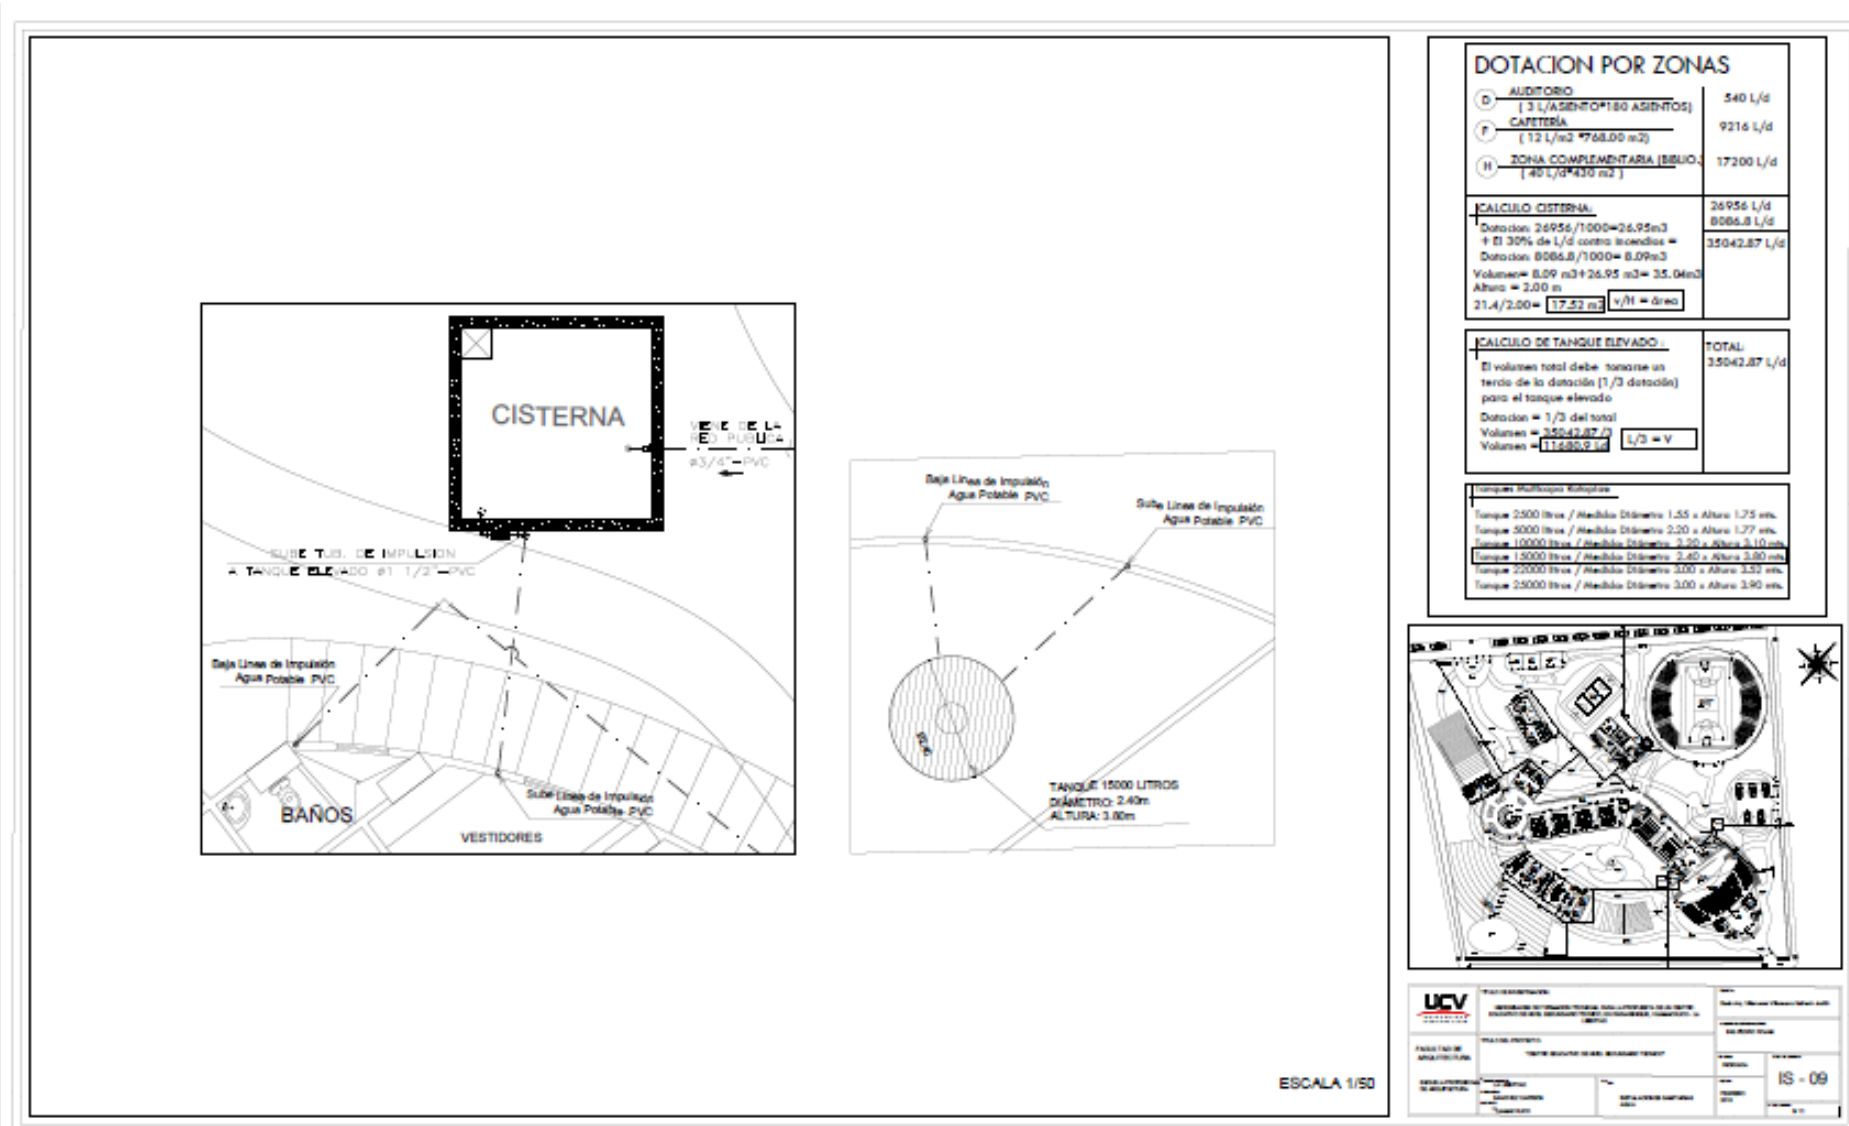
Plano de Diseño de Instalaciones Básicas Detalle – Agua - Plano N° 30 - Lamina IS-09
